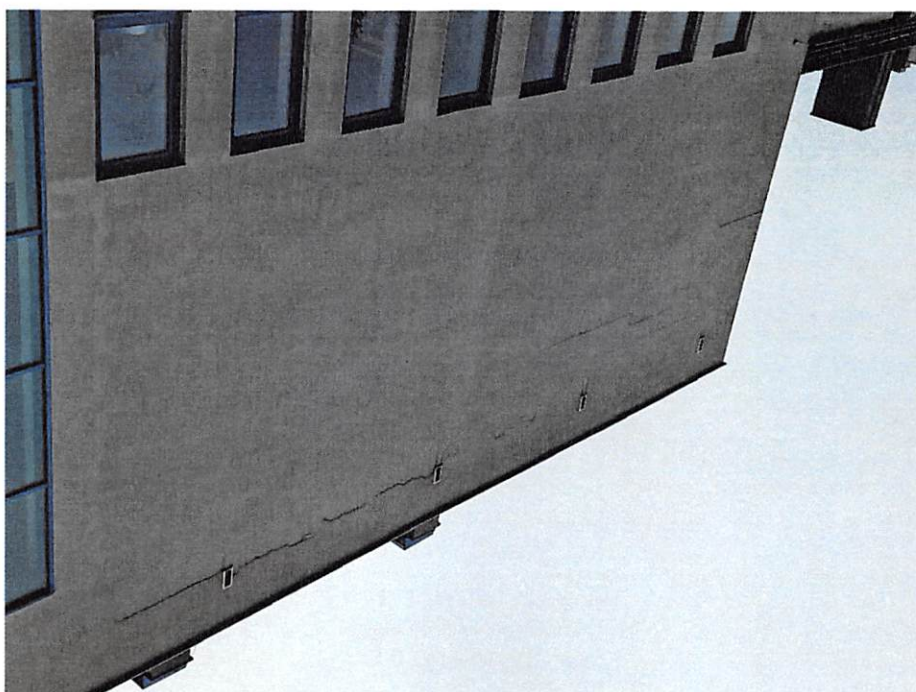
Pęknięcia tynku na elewacji przy dachu nad salą gimnastyczną.
